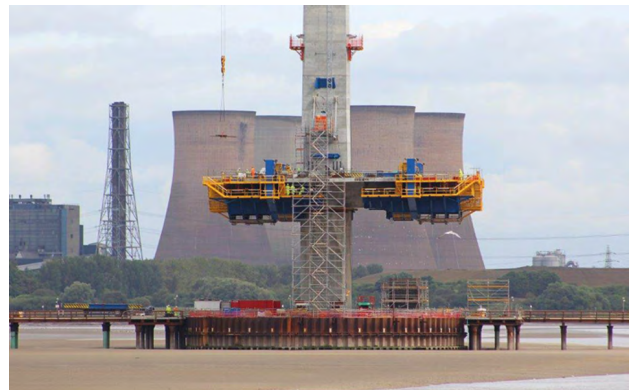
Distintas perspectivas de construcción de tablero del puente.
